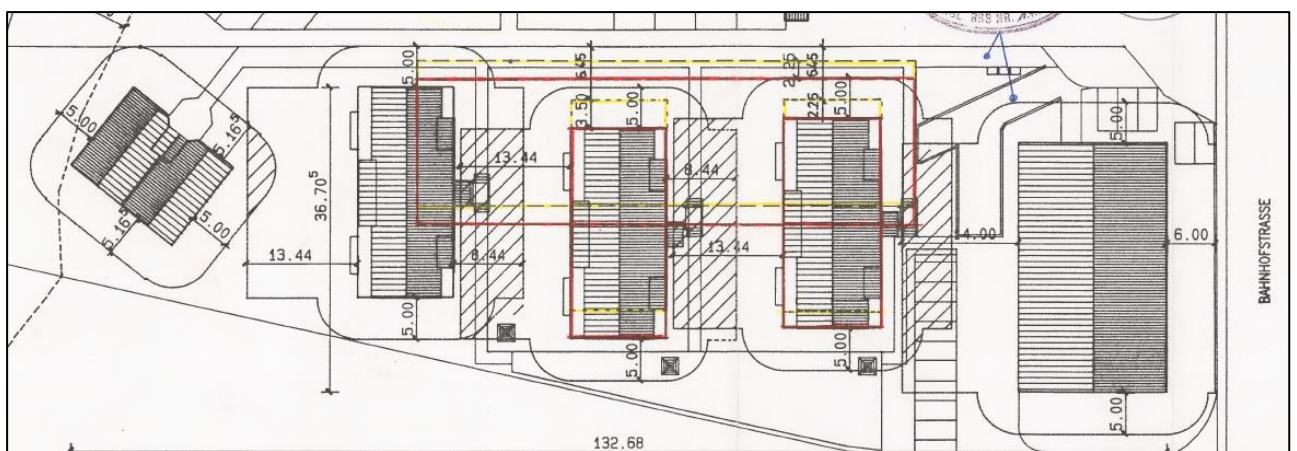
Gestaltungsplan Mühlebach: Plan 1 (Gebäudeausdehnung und Grenzabstände).
